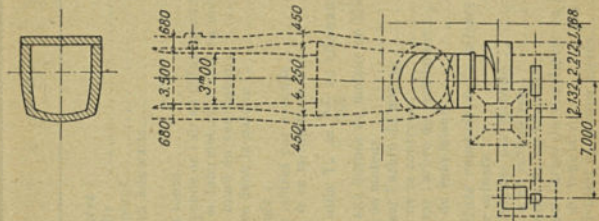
Plan d'installation d'un ventilateur hélico-centrifuge.
